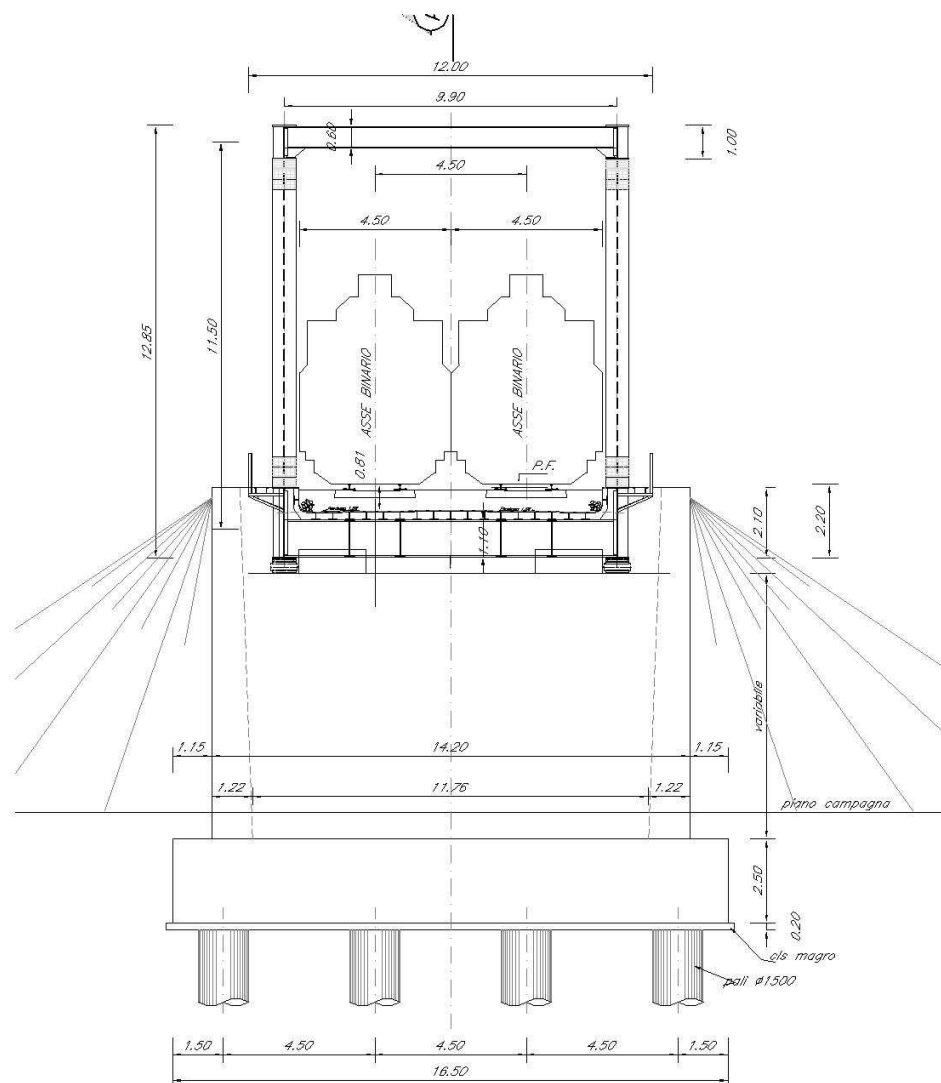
Pianta fondazioni della spalla tipo.
